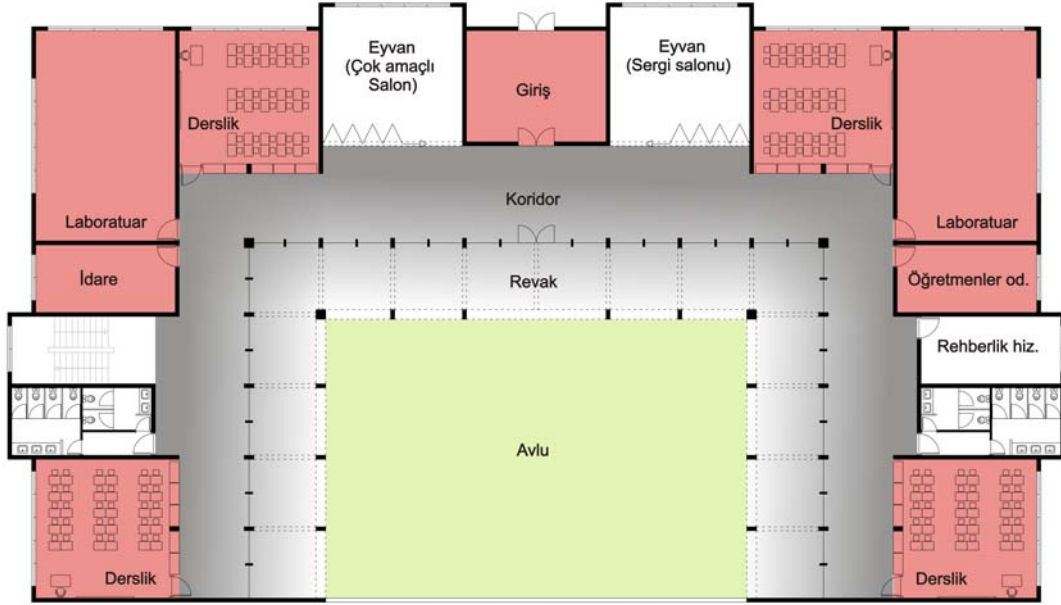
Beş derslikli ilköğretim okulu plan şeması
